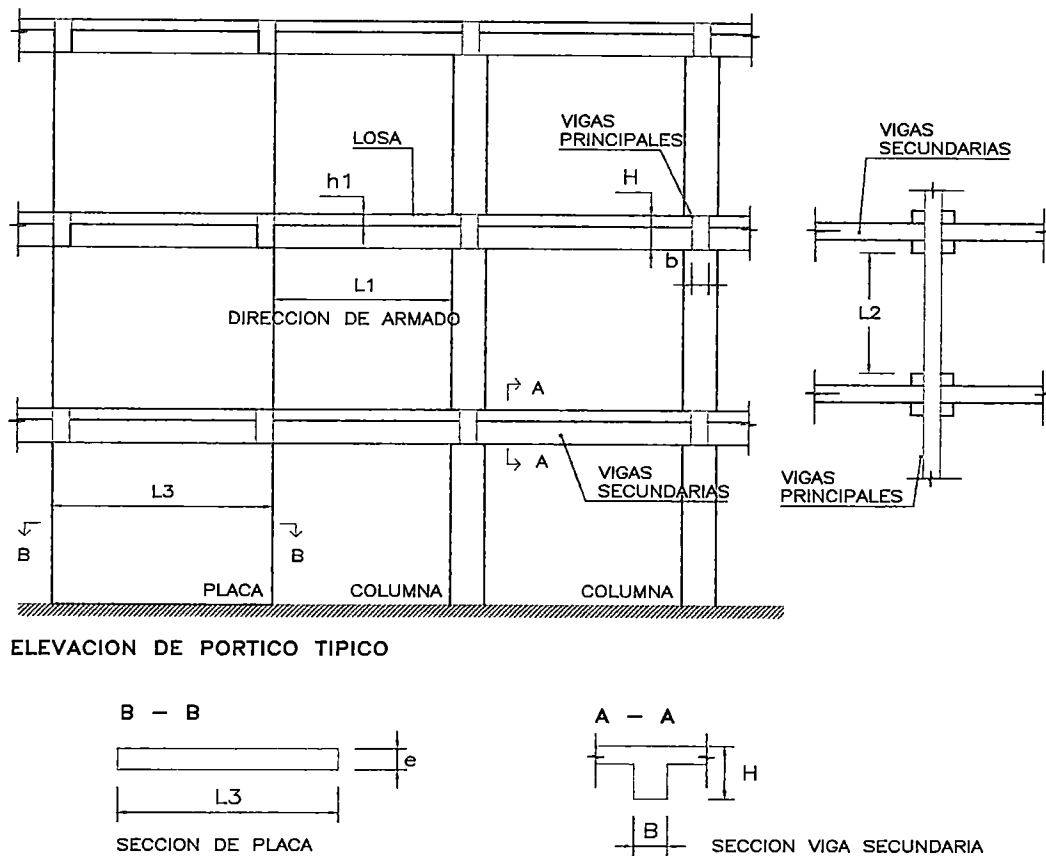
VARIABLES PARA EL PREDIMENSIONAMIENTO DE LOSA, VIGAS Y PLACAS
